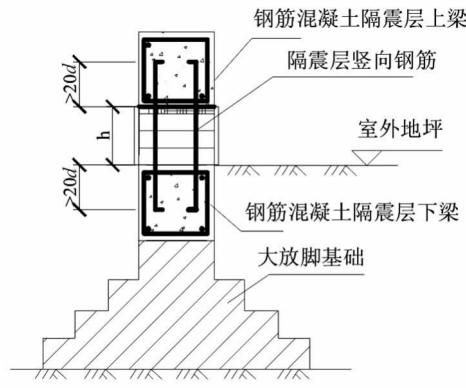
隔震层竖向钢筋锚固示意图
